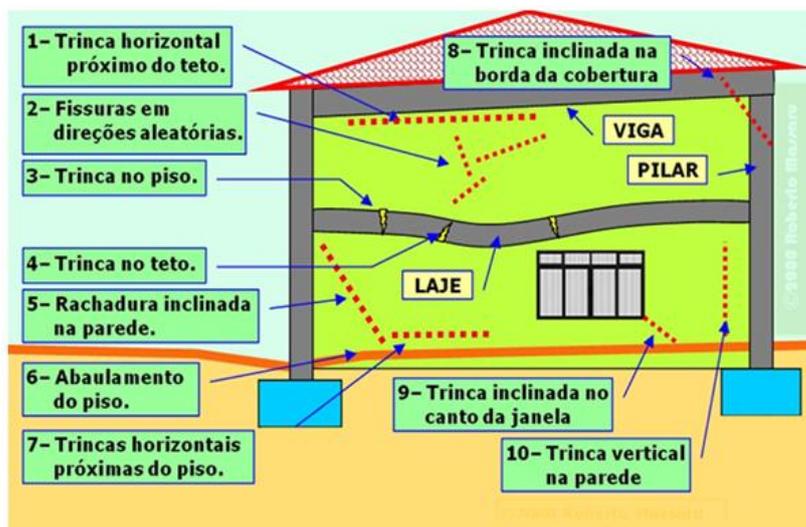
Trincas e fissuras por movimentação estrutural. Fonte: FazFacil
